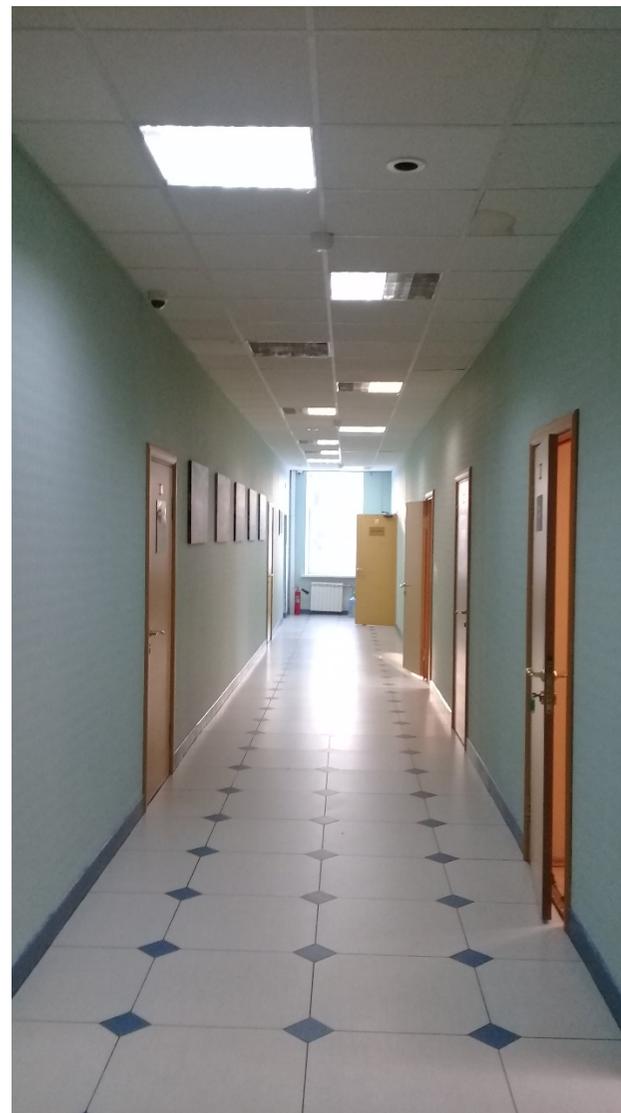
Помещение коридора № 69 (по плану ПИБ 2018 г.).
